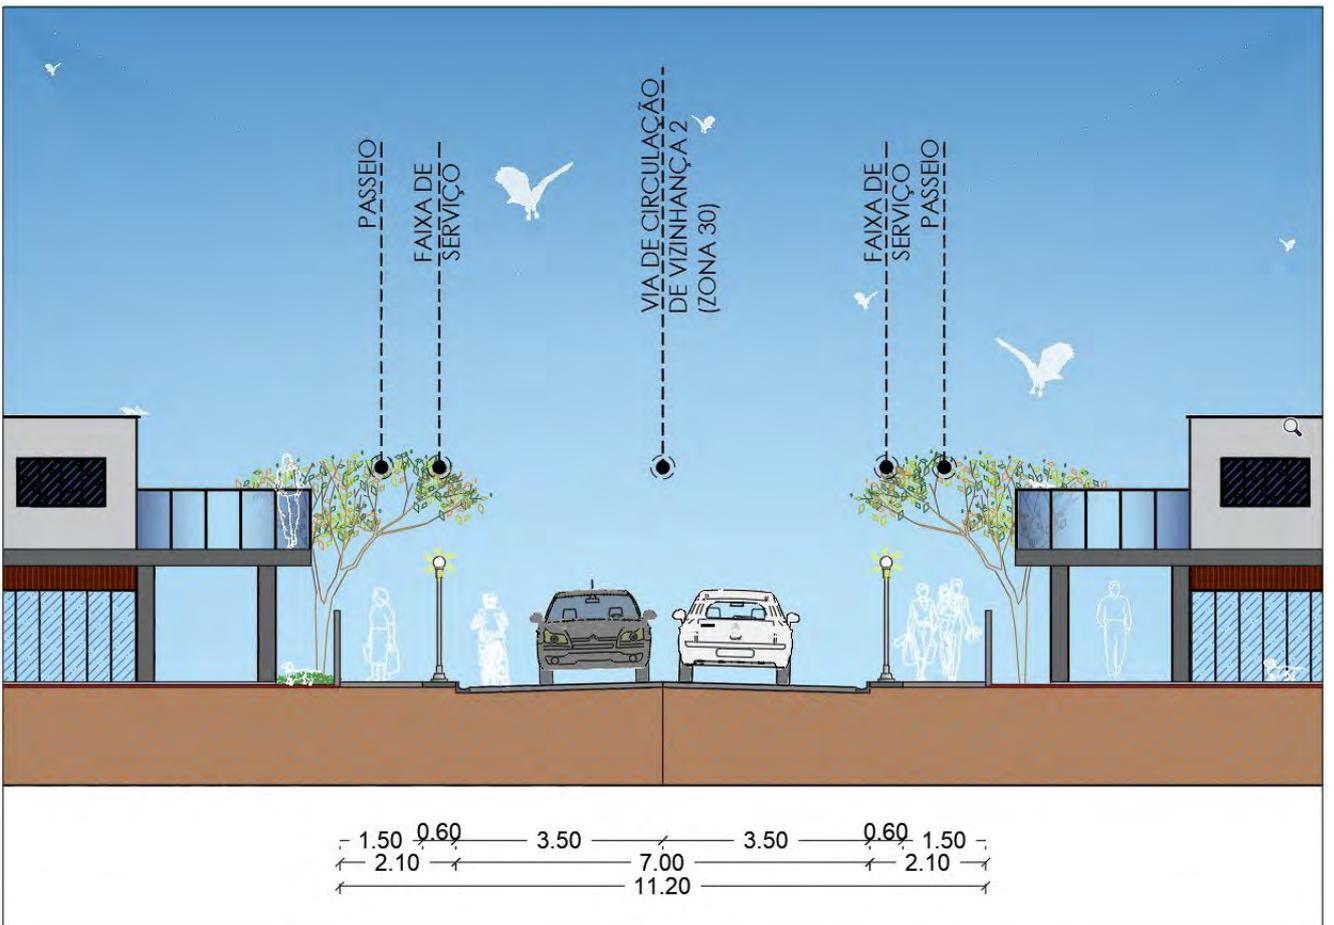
Perfil 2 – Via de Circulação de Vizinhança 02
